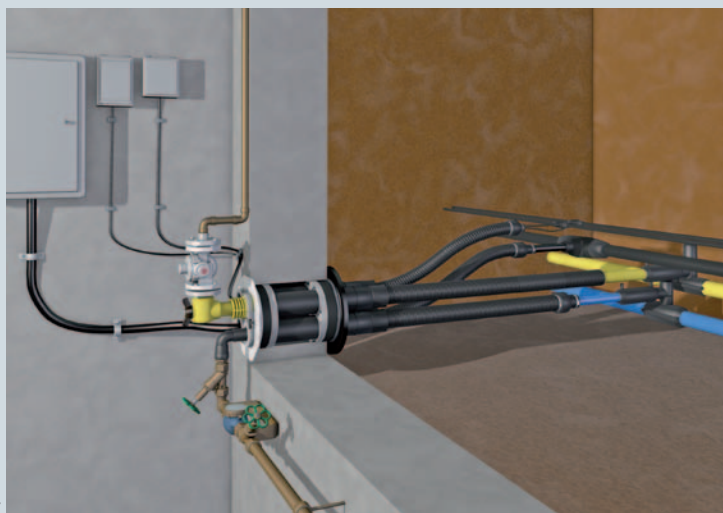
Mehrspartenhauseinführung mit Leerrohrtrasse
